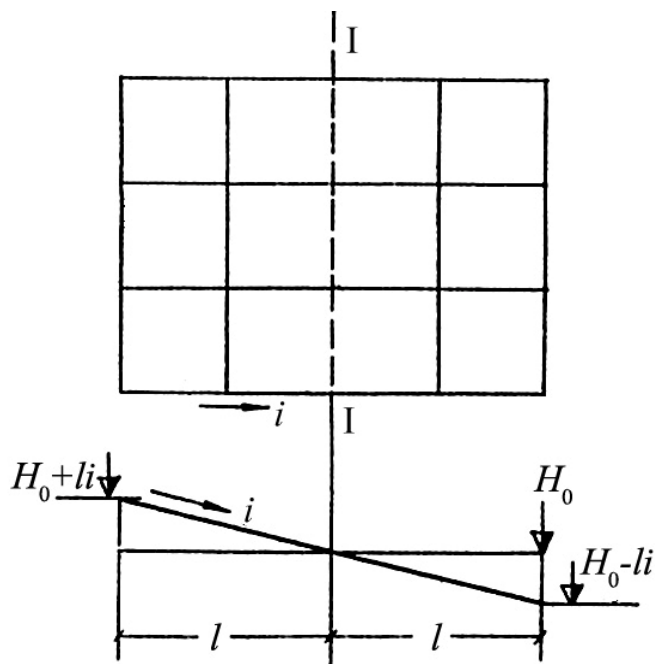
К определению красных отметок при планировке площадки с уклоном
